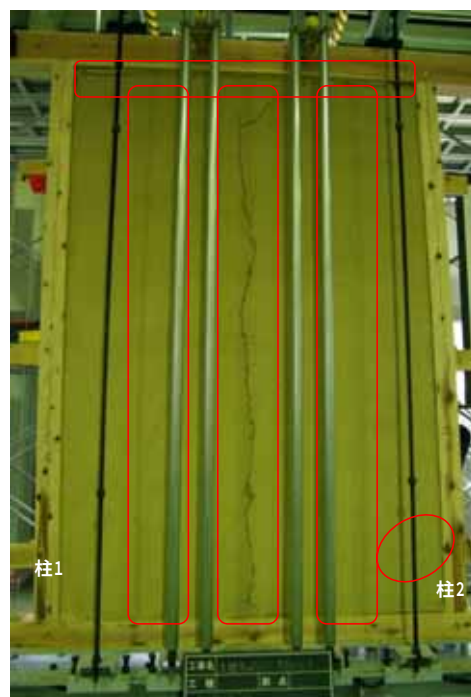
中塗側 1/50rad 中央間柱のひび割れ拡大、柱側の間柱のひび割れ、隅角部圧壊の拡大、地貫のこじり効果と柱と土台によるひび割れ
